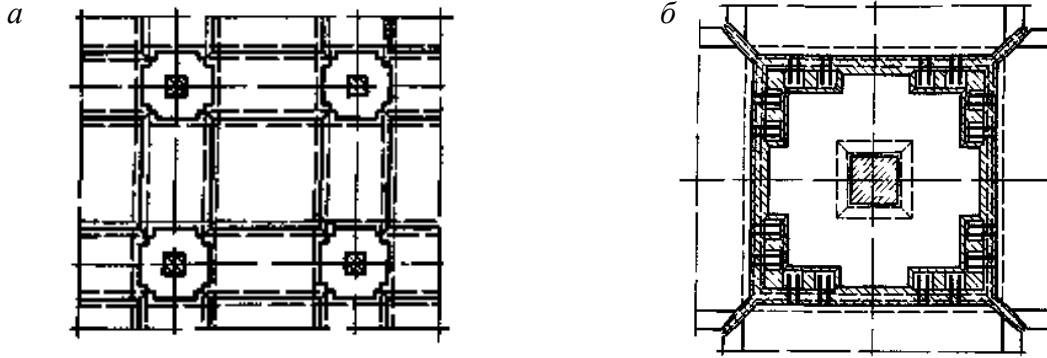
Конструкції збірних безбалкових перекриттів:
